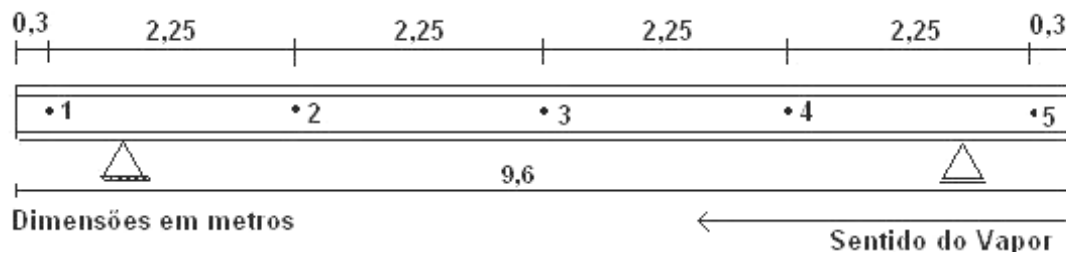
Esquema de distribuição dos multímetros ao longo da viga
